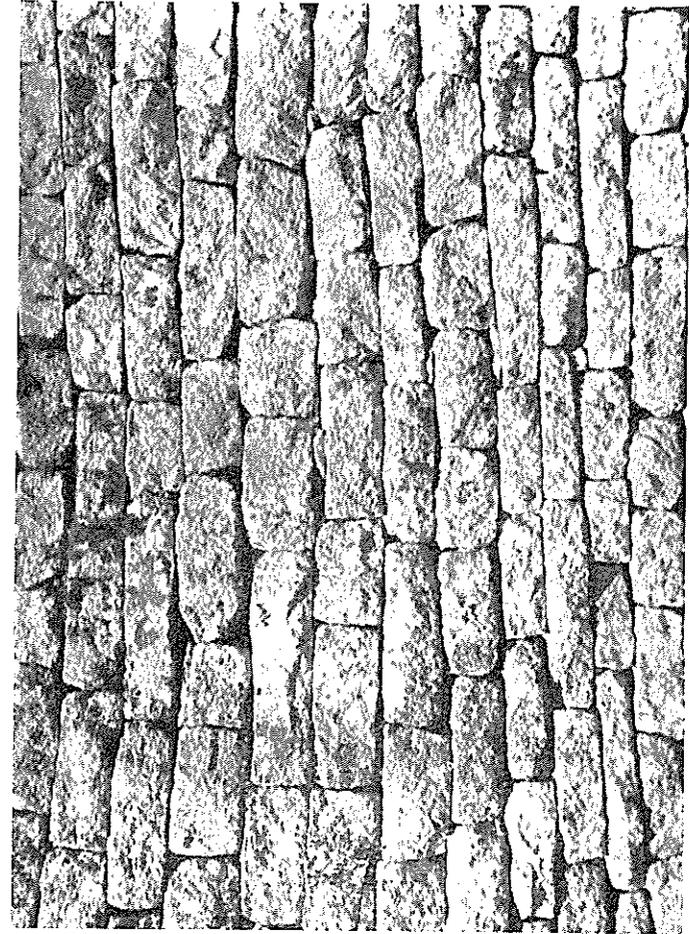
Pormenor da muralha do templo elitico de Zimbaué, para mostrar a sua construção feita com pedras de secção rectangular sem interposição de qualquer cimento ou argamassa. A este tipo arquitectónico pode bem chamar-se *opus rectangularis*.
